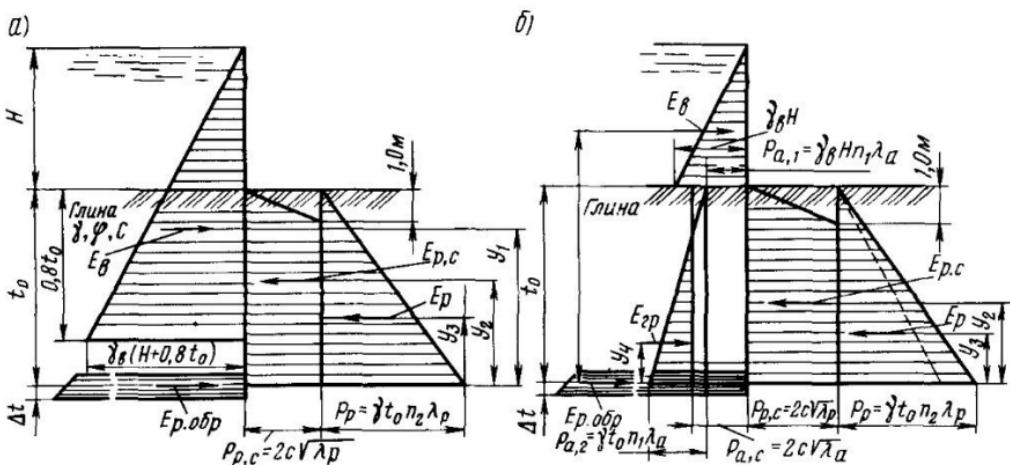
Схема для расчета свободно стоящей стенки в связных грунтах: а—по первой стадии; б—по второй стадии
